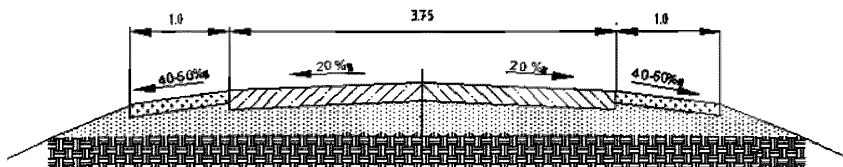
Покрытие – железобетонные плиты; основание – песчаный подстилающий слой; обочины – грунт, улучшенный добавками скелетных материалов или местный каменный материал
